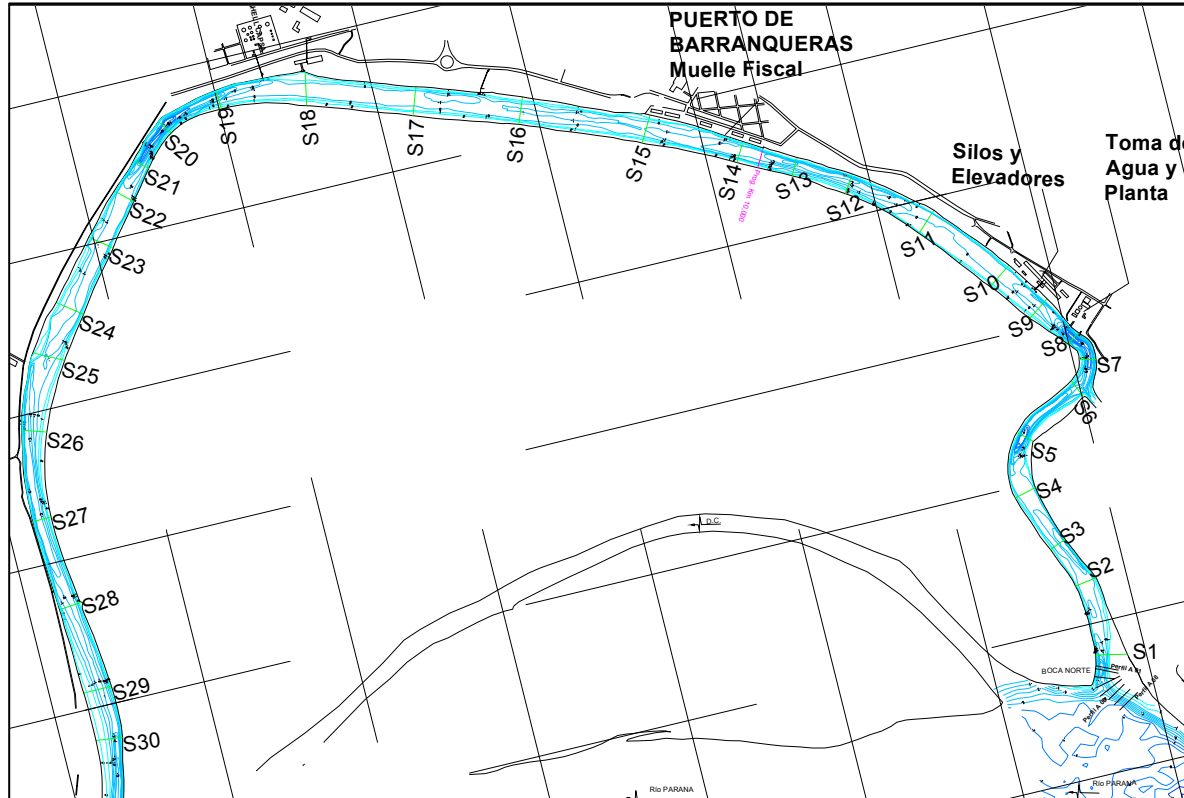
Planta del riacho Barranqueras con ubicación de las 31 secciones
